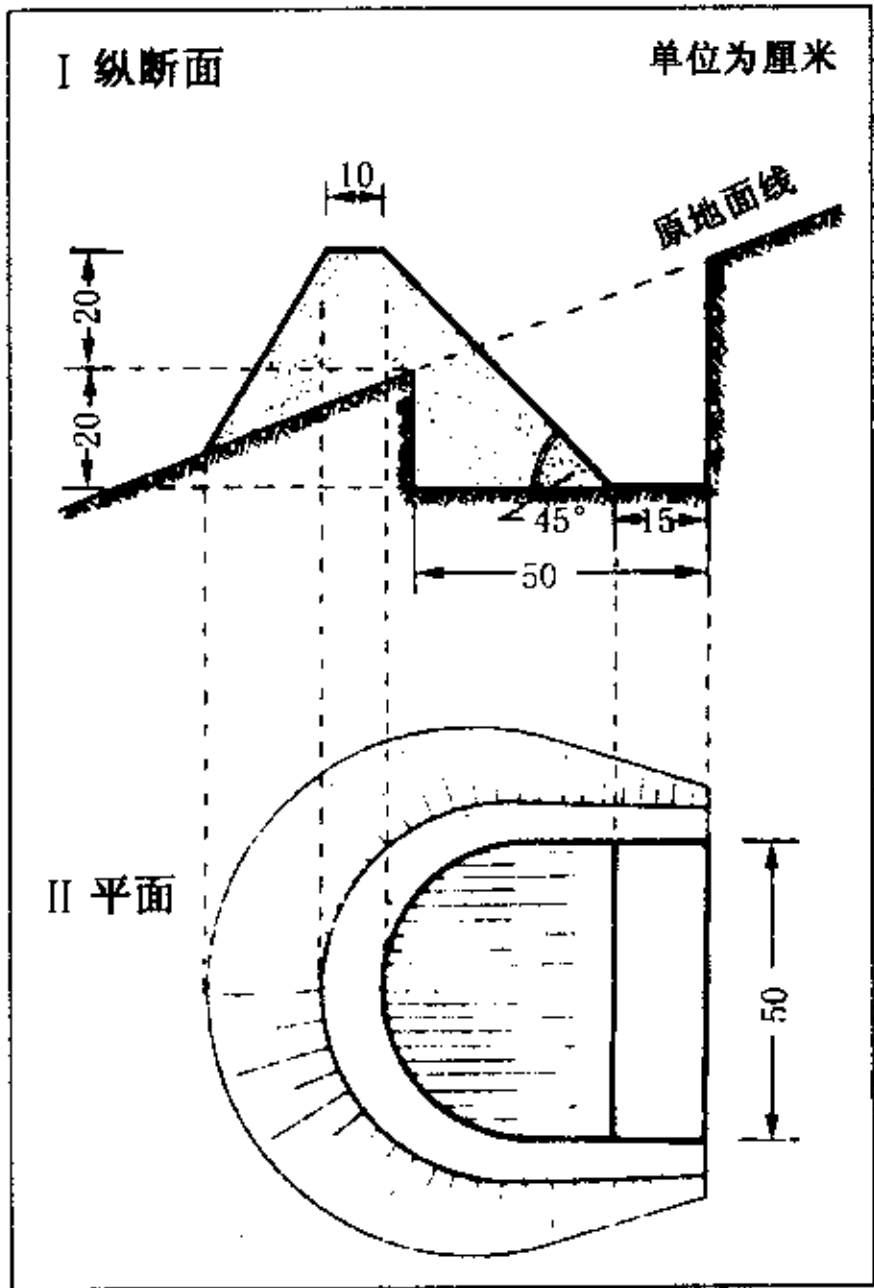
反坡鱼鳞坑整地纵断面、平面图
